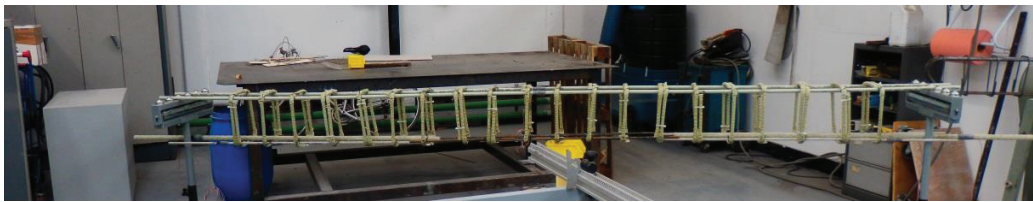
Cage d'armatures de la poutre du portique G3
